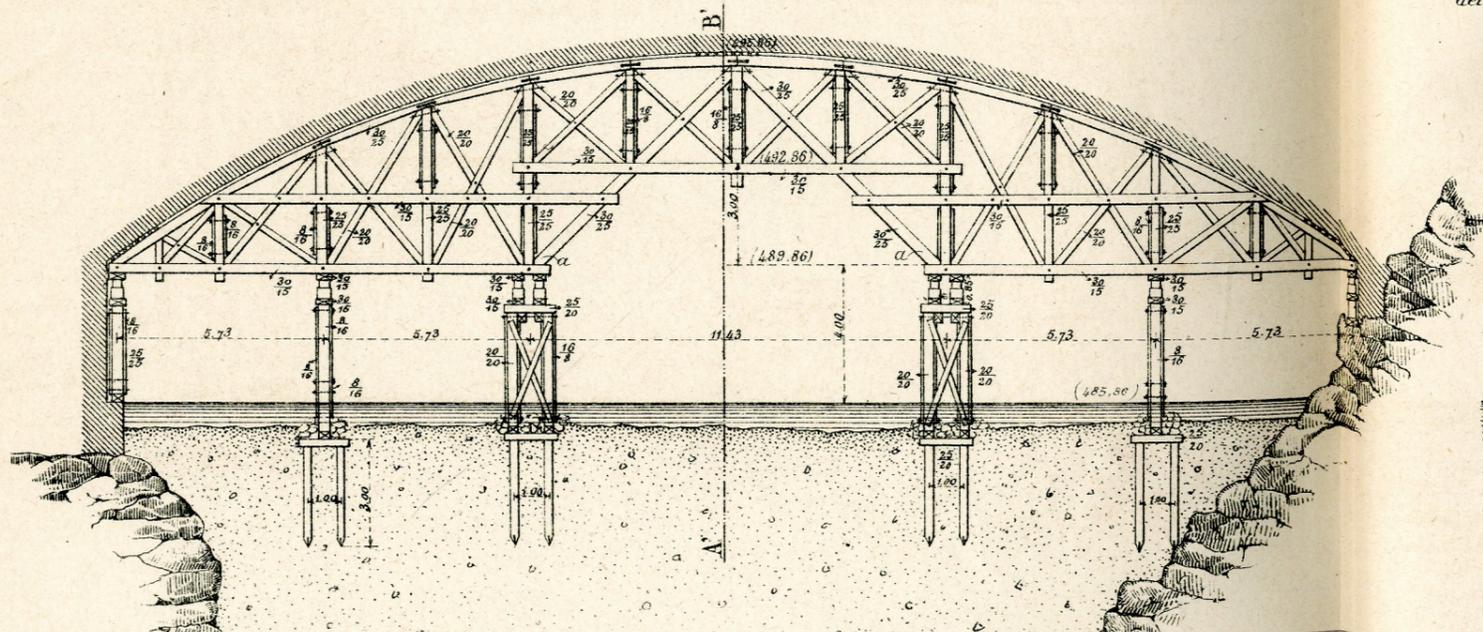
Sezione trasversale dell'armatura secondo A'B.
